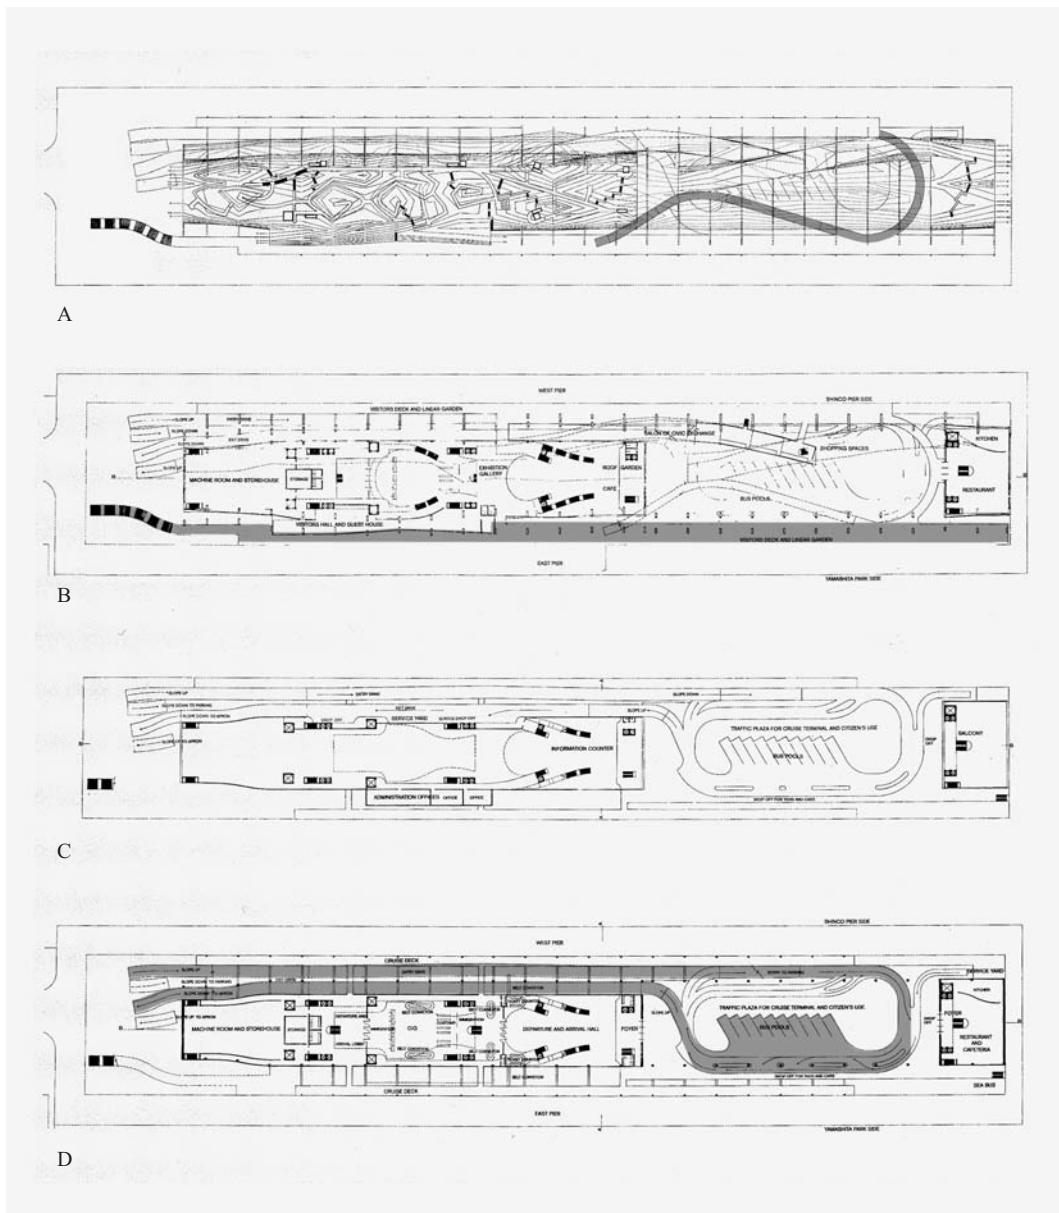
Jesse Reiser und Nanako Umemoto, Yokohama International Port Terminal, Japan, Entwurf 1994. Dachaufsicht (A), Grundrisse zweites Obergeschoss (B), Zwischengeschoss (C) und erstes Obergeschoss (D), Computerzeichnungen (graue Unterlegungen von der Verf.).
